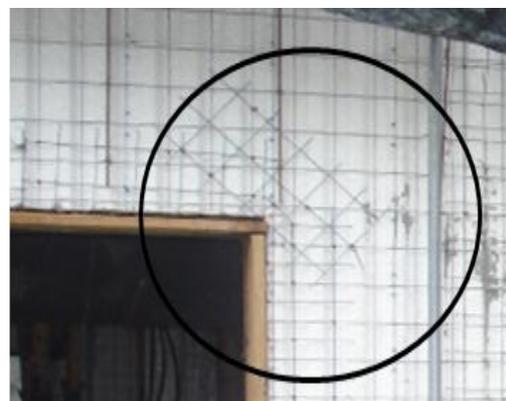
Aplicación de malla de refuerzo plana. Conjunto habitacional "Las Ramblas". Fuente: El Autor.
